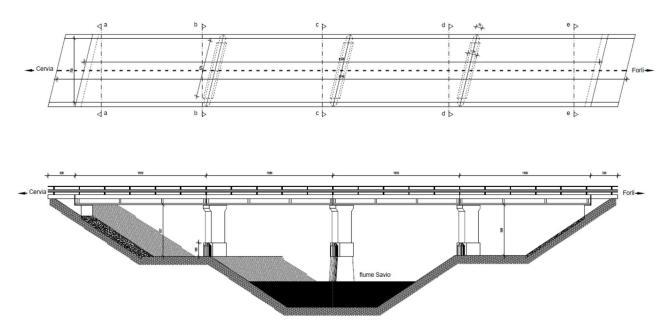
PIANTA IMPALCATO E SEZIONE LONGITUDINALE DEL PONTE
